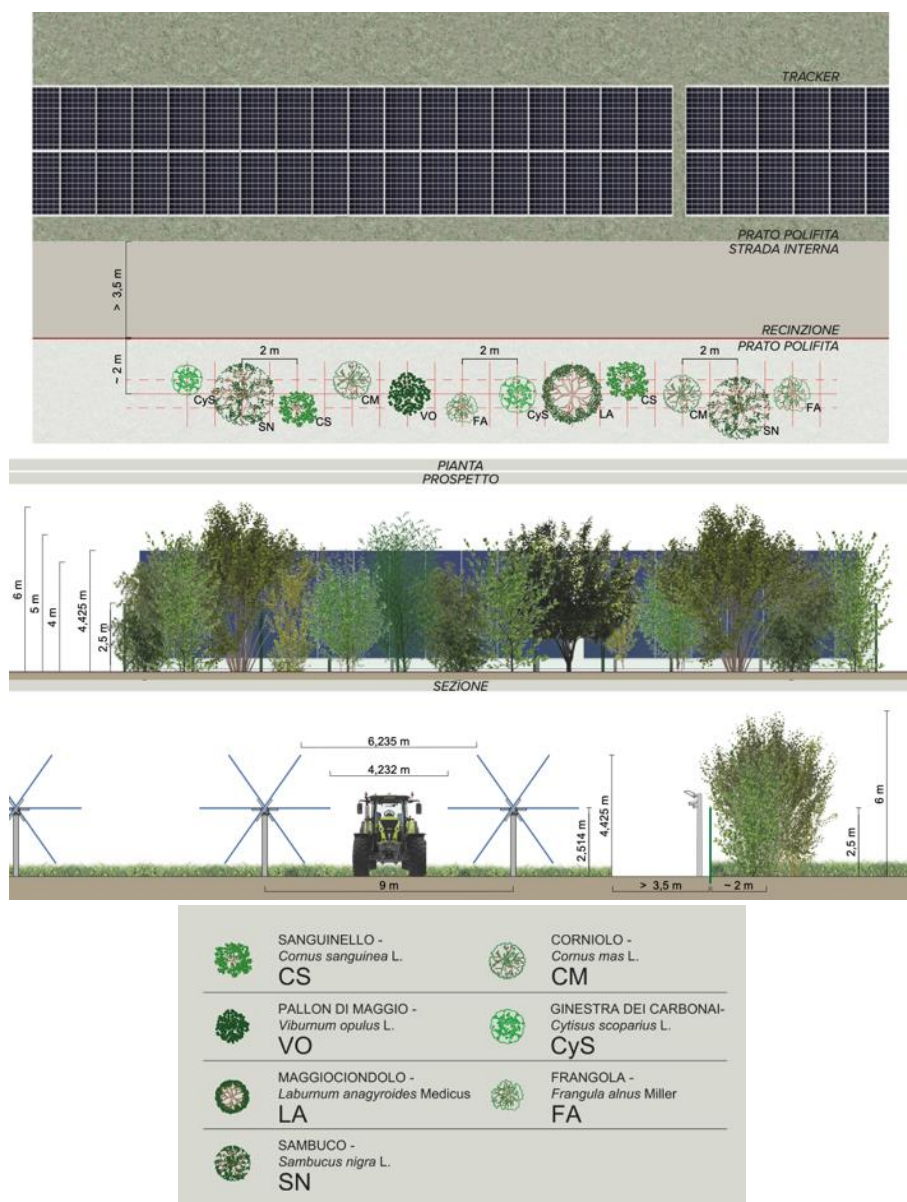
Sesto di impianto, prospetto e sezione delle fasce vegetate di Tipo 3.
